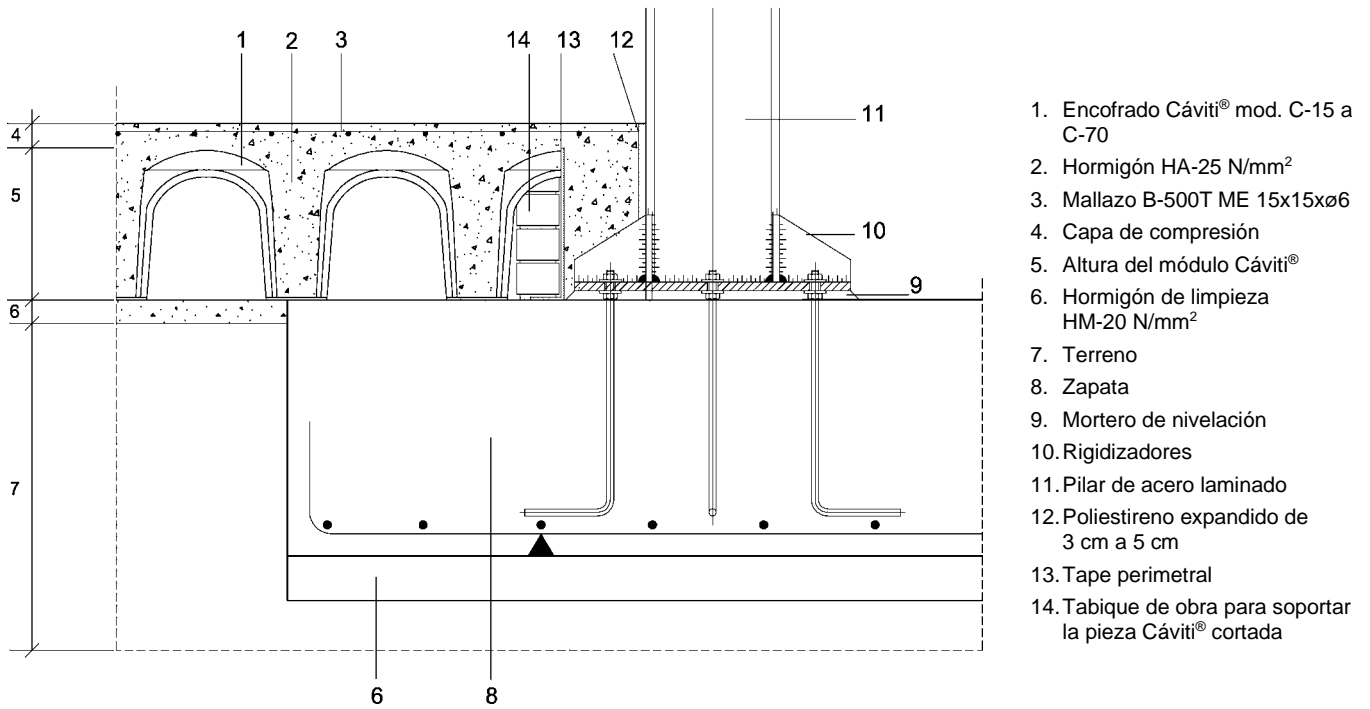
Encuentro con pilar metálico. Módulo separado.
